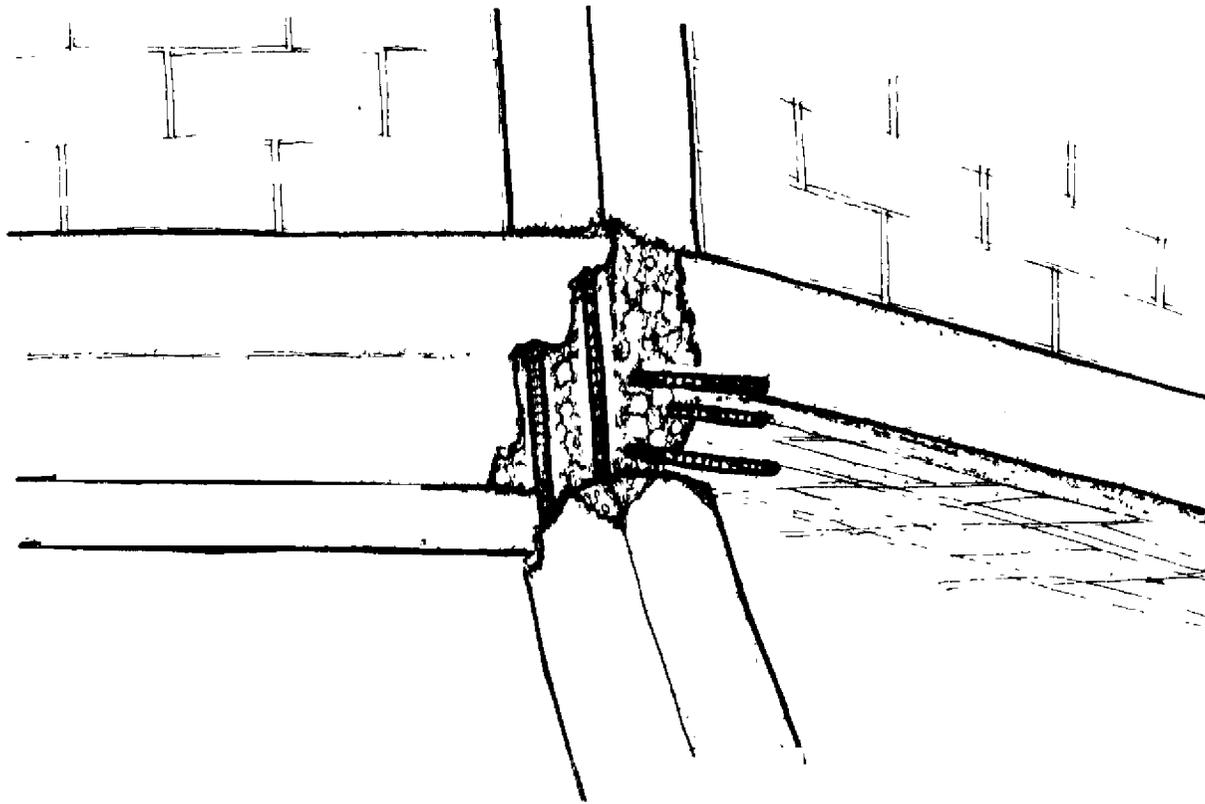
Falta de estribos de confinamiento. Falta de anclaje. Alta rigidez de la unión viga-losa con relación a la columna.
